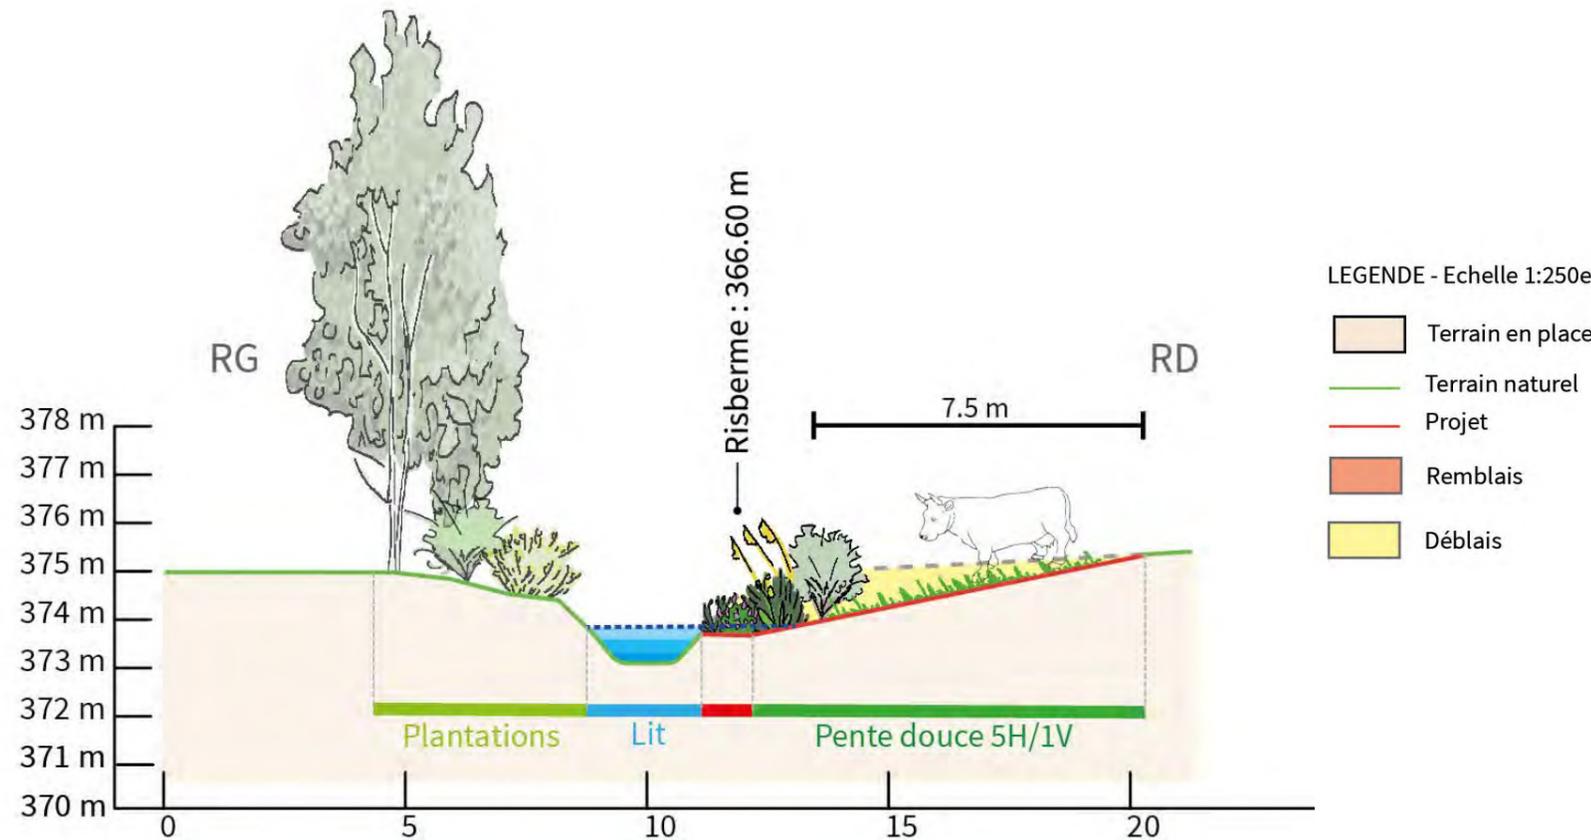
coupe de principe de la restauration des berges de la partie aval du ruisseau de Véria (coupe 1)
